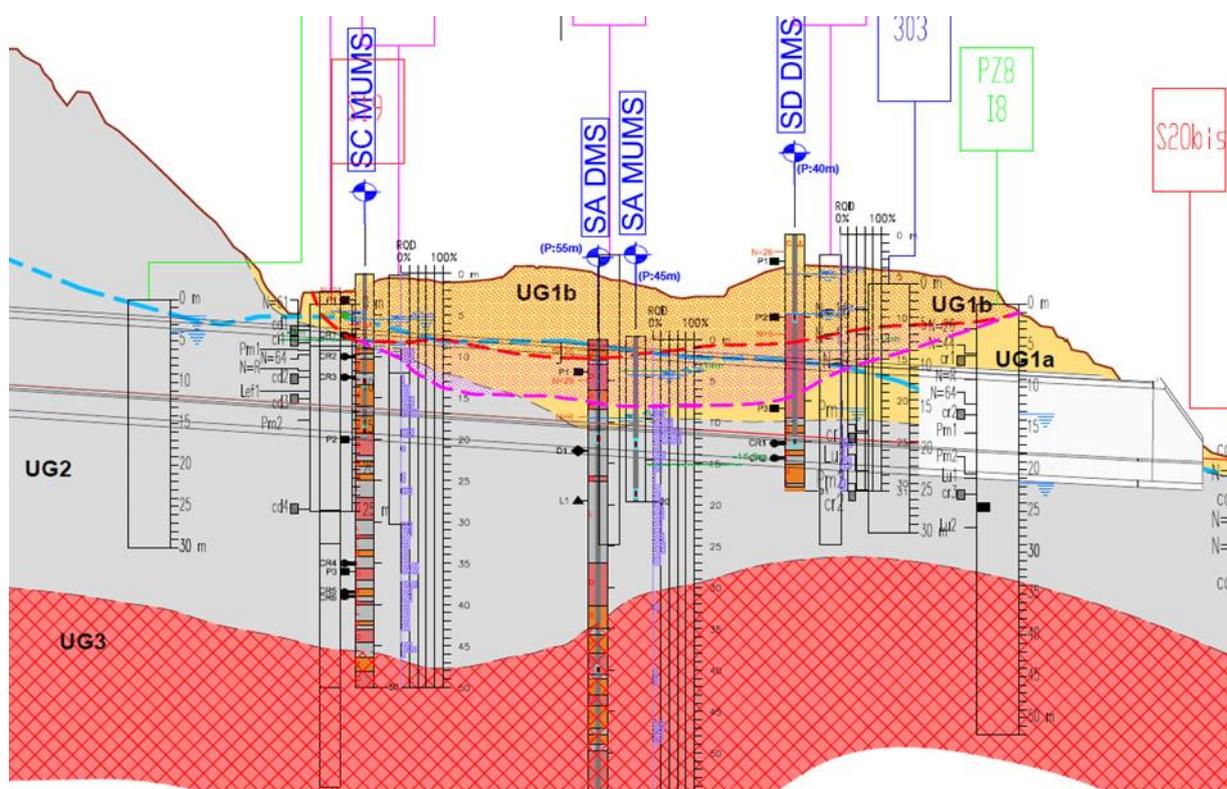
Stralcio del profilo Geotecnico in asse al tracciato
